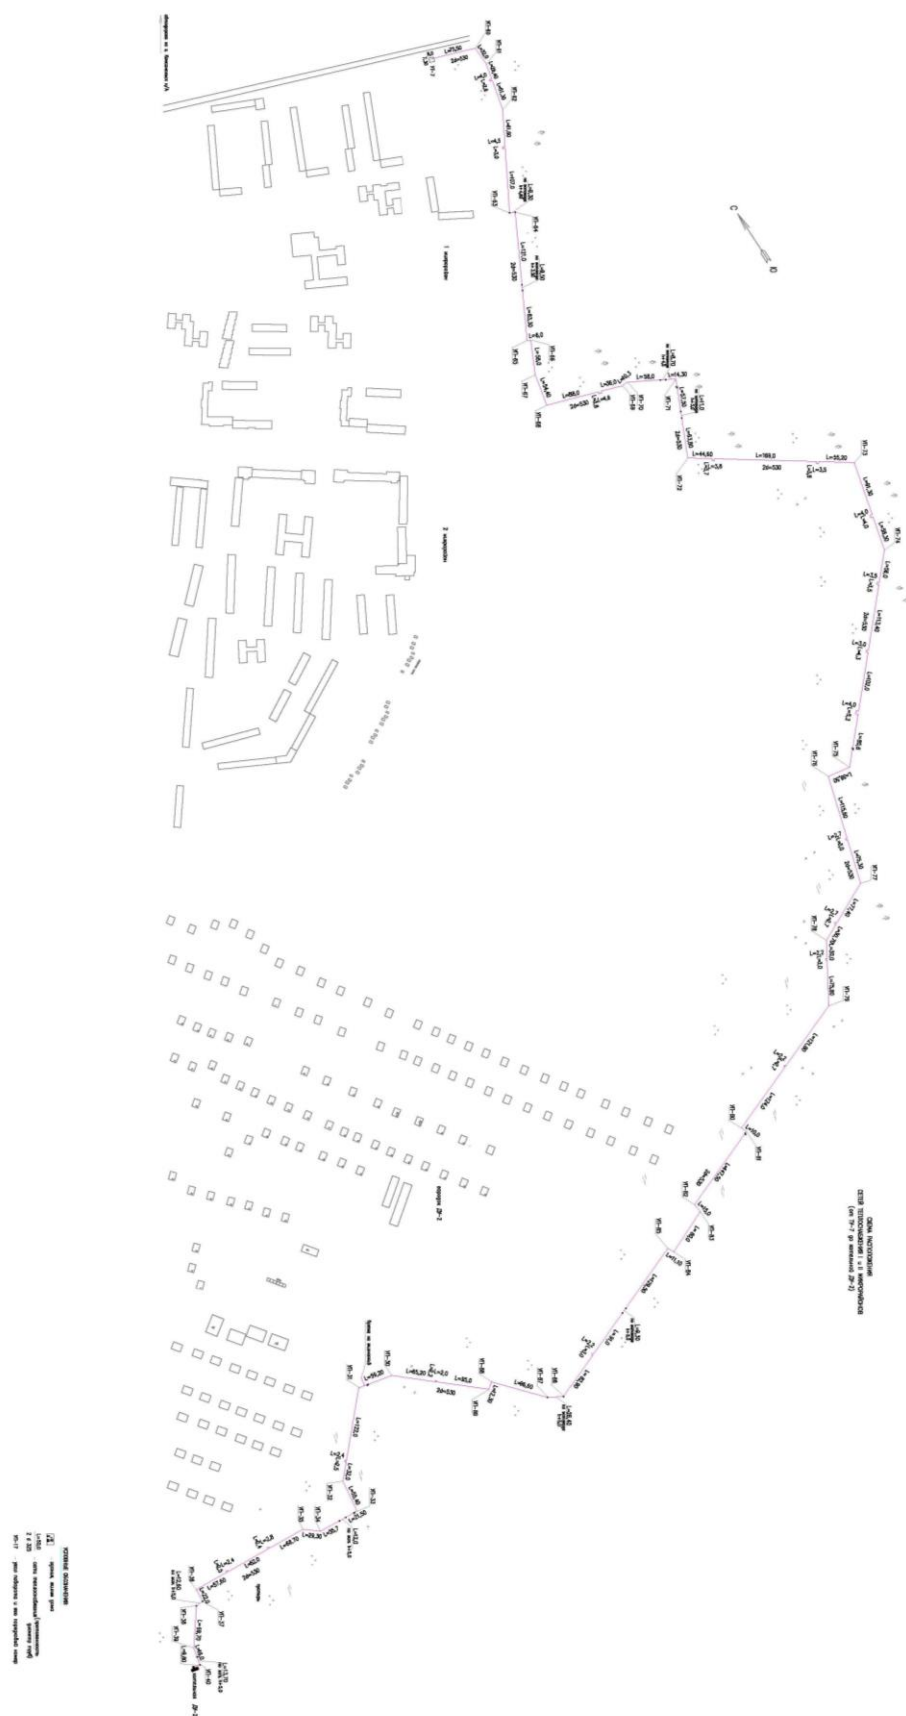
Схема транзитного трубопровода от УТ-7 до котельной ДУ-2
